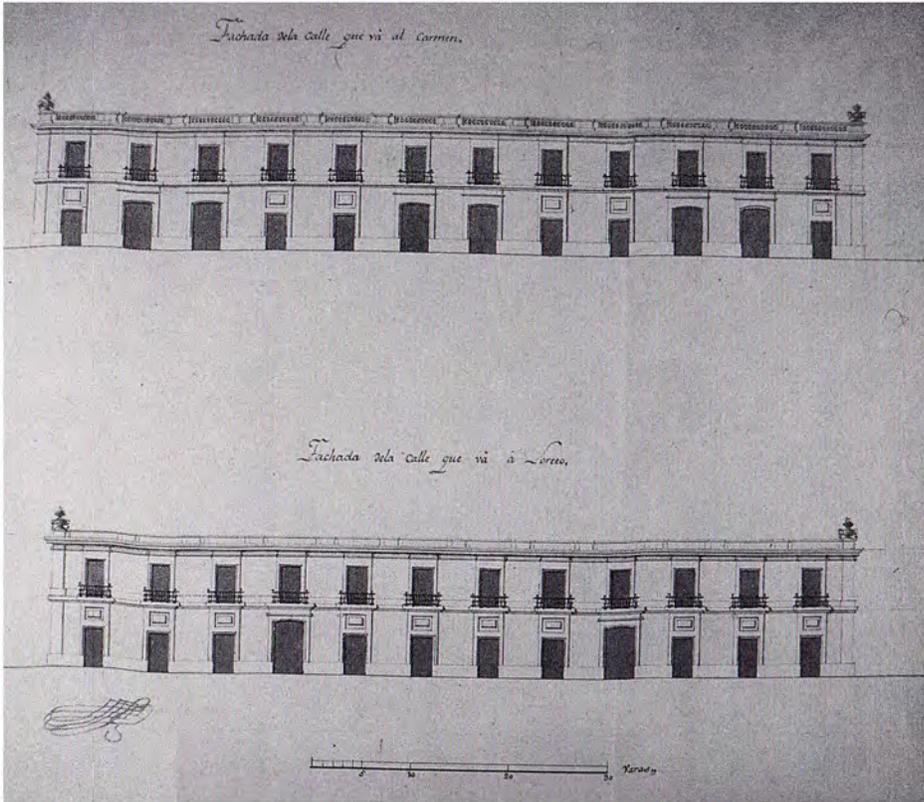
Fachadas de las Casas de San Pedro y San Pablo, proyecto de Ignacio de Castera
